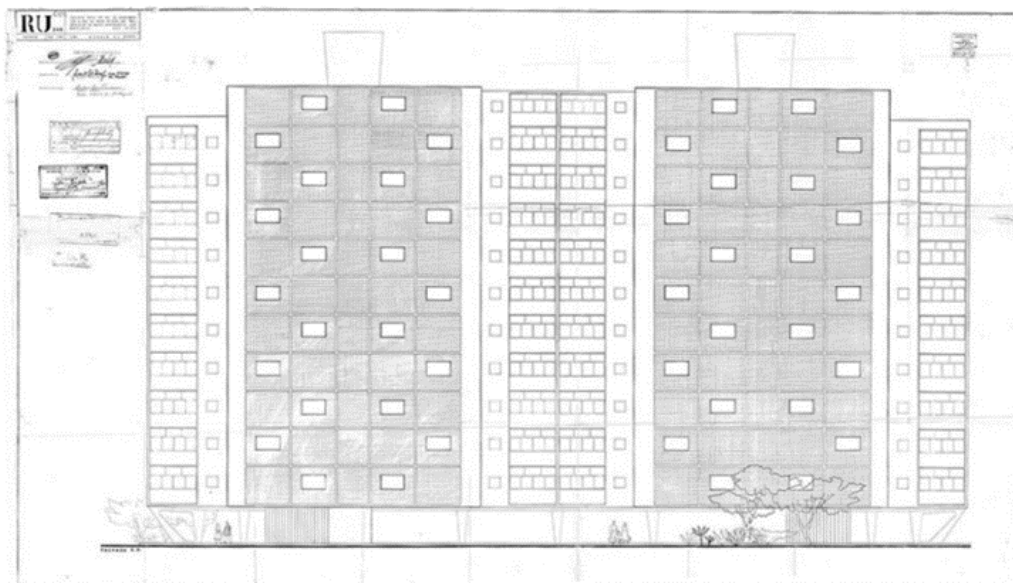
Fachada Edif. União, 1953 do arquiteto Acácio Gil Borsoi. Fonte: Acervo Borsoi, in: Bachmann (2021, p. 48).
